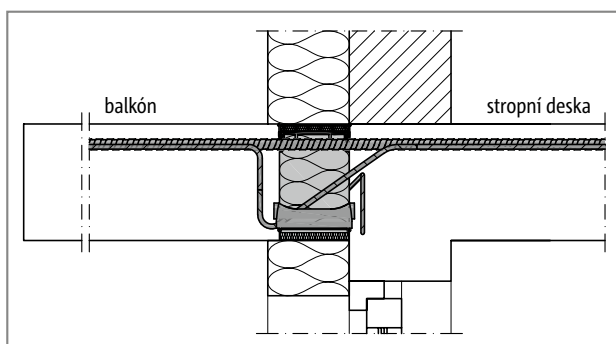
Schöck Isokorb® CXT typ KL: Balkón na zalomené fasádě (částečně zapuštěný)
